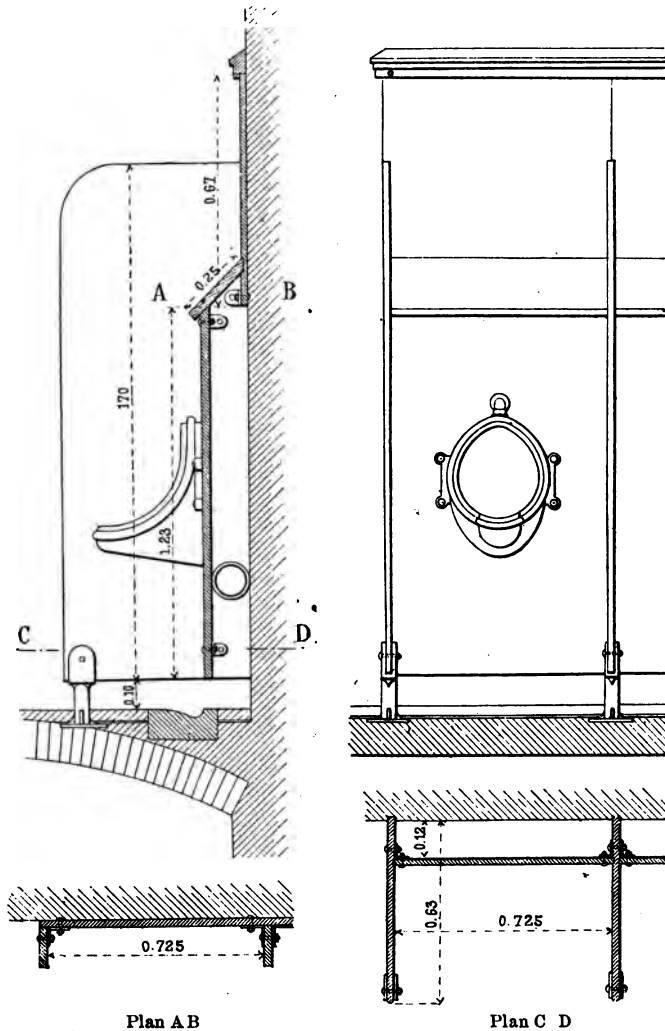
Plans, coupe et élévation d'une case d'urinoir.
